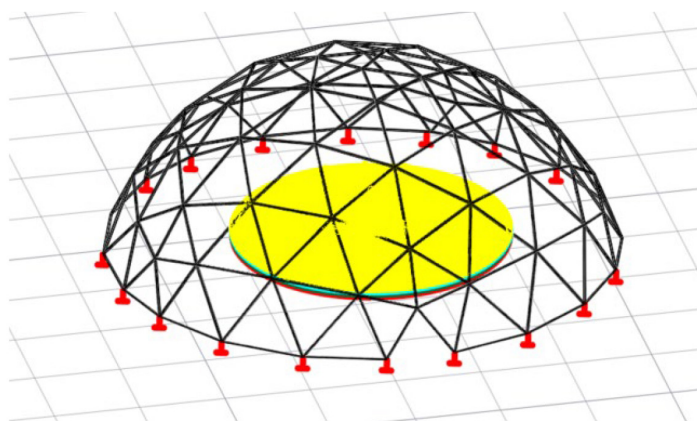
Установка купола на опорные подошвы и сдувание подушки
